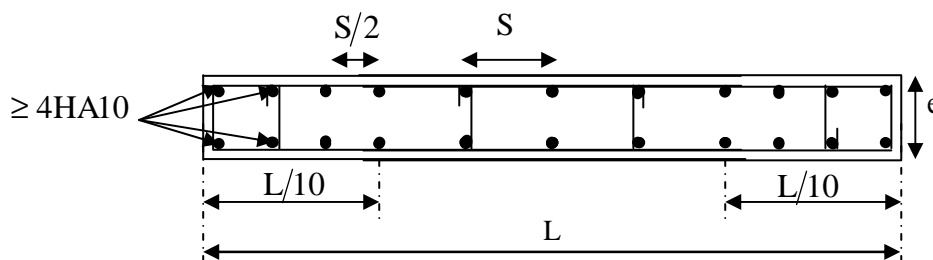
Disposition des armatures verticales dans les voiles.
